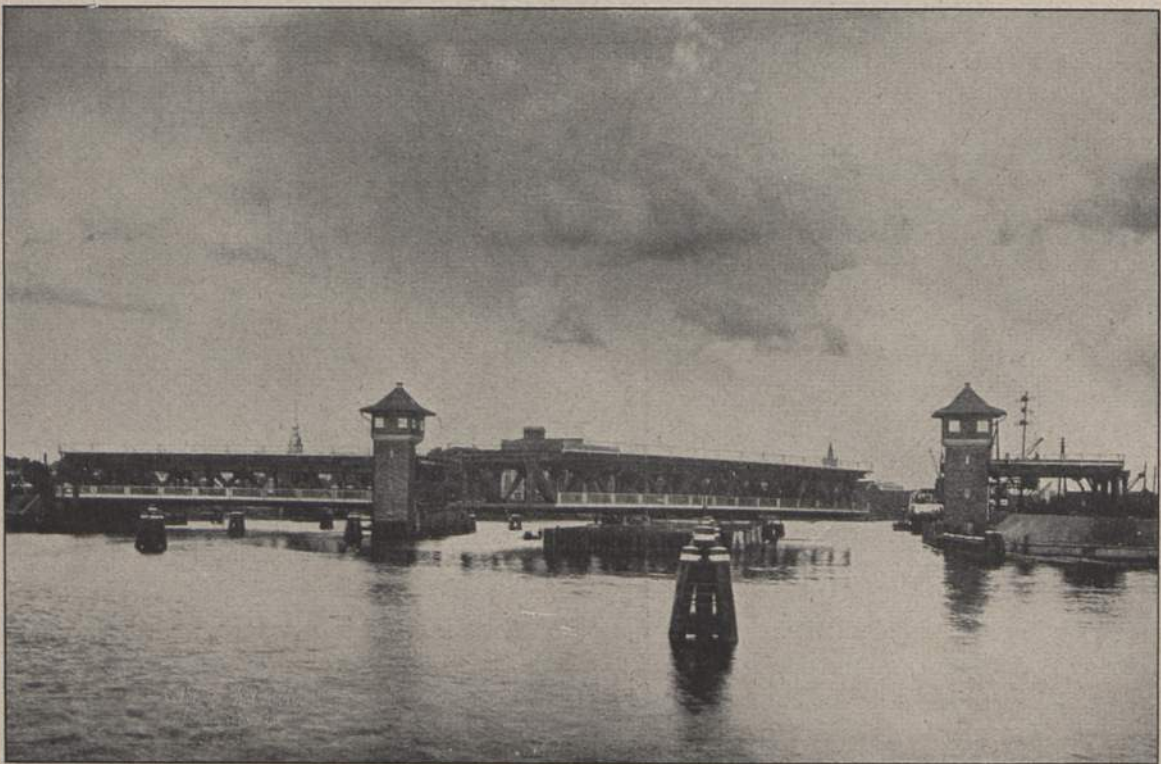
Ansicht dieser Drehbrücke in halbgeöffnetem Zustand.
